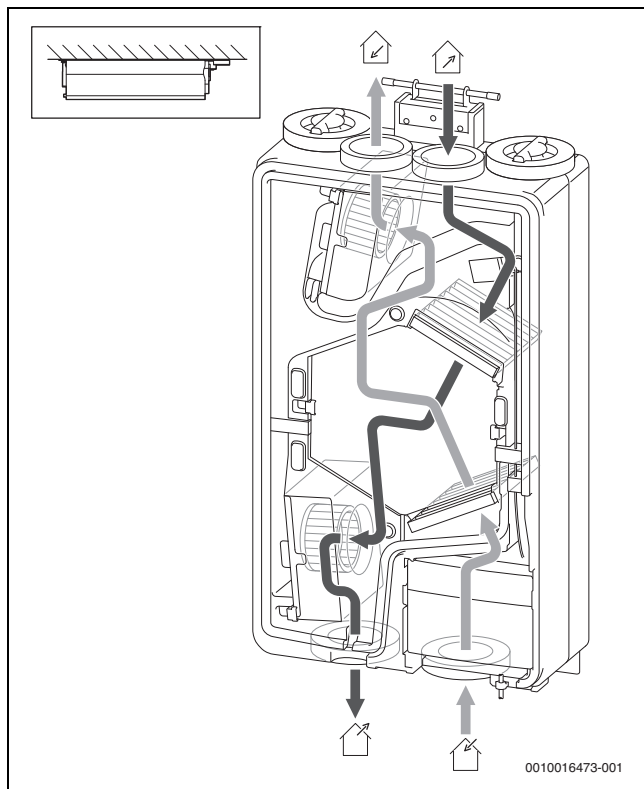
Luftseitiger Geräteanschluss bei Deckeninstallation
